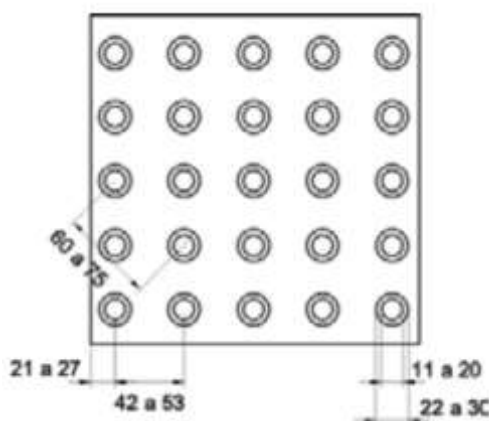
Sinalização tátil de alerta – modulação do piso (dimensões em milímetros)
